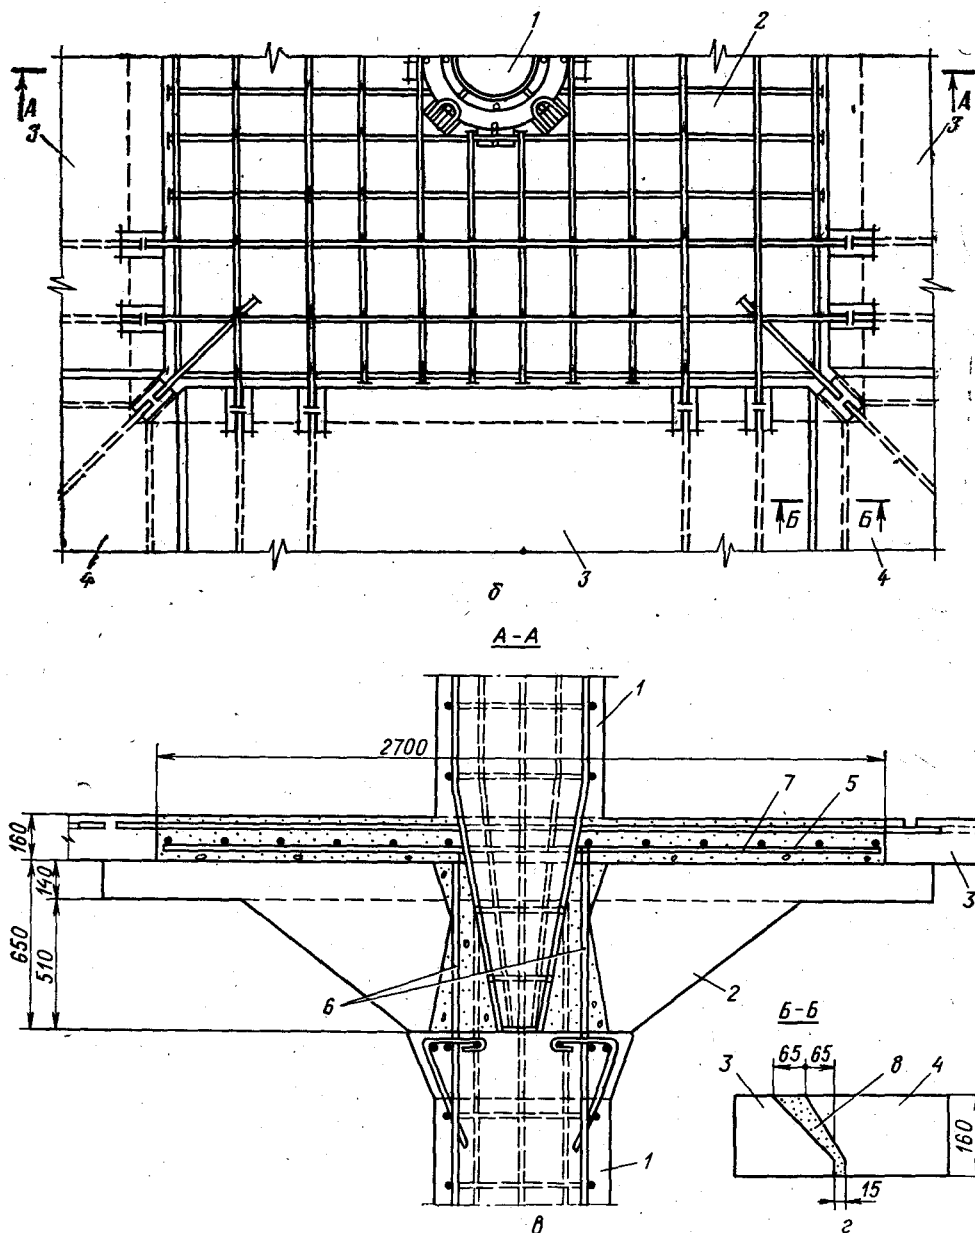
Сборные железобетонные безбалочные конструкции Гипрохолода:
